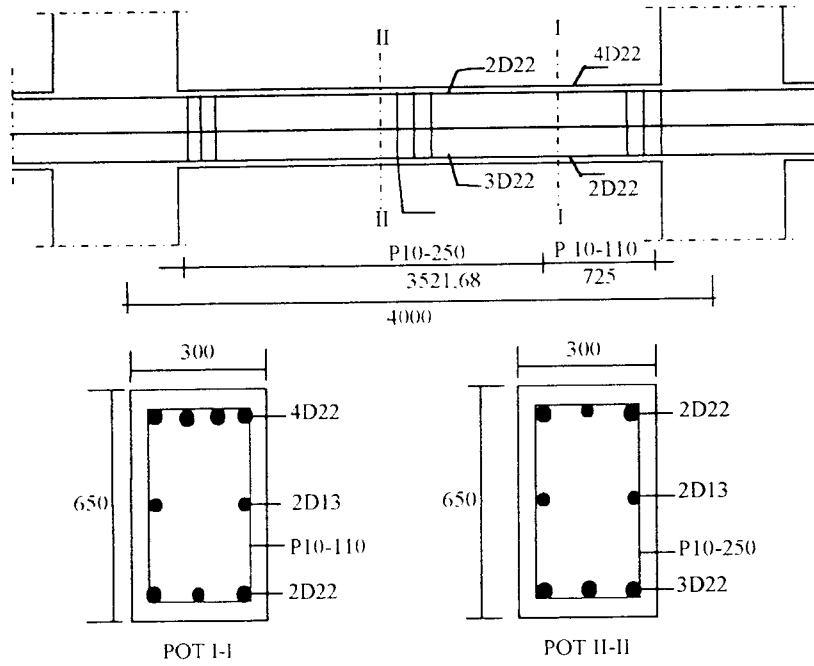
Balok Portal E Bentang 4 m Lantai 7
